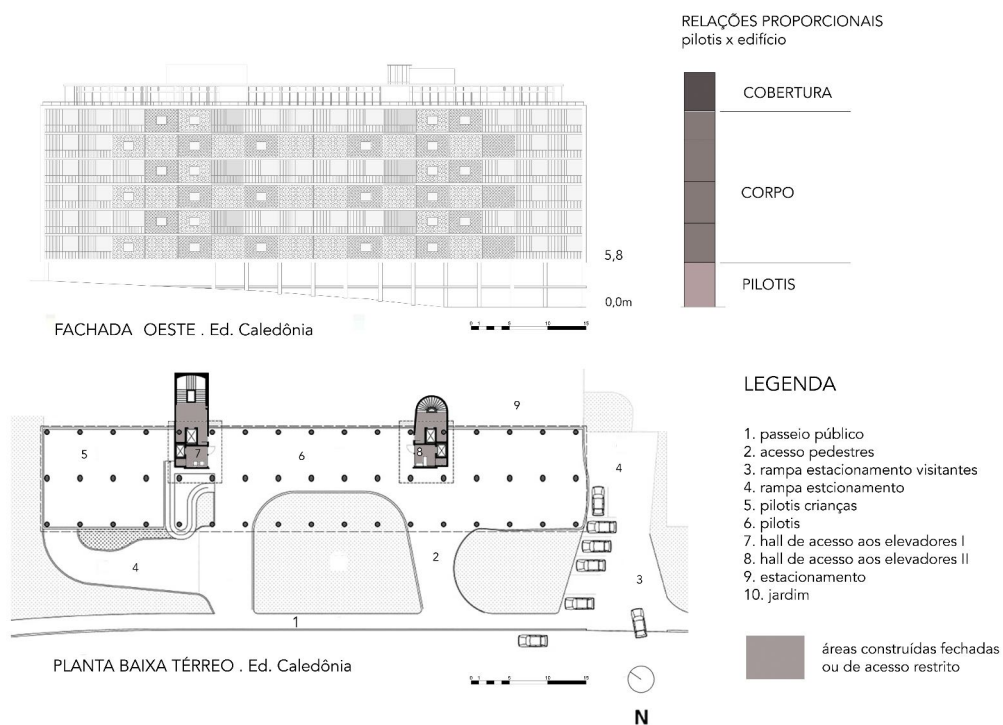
Plantas baixas do nível térreo do Edifício Caledônia. Fonte: edição da autora sobre redesenho de fachada de Alex Brino (BRINO, 2005) e planta de ARCOWEB < <https://revistaprojeto.com.br/acervo/a-forca-da-pequena-escala-na-arquitetura-de-dois-abrigos/> acessado em dez. 2020.
